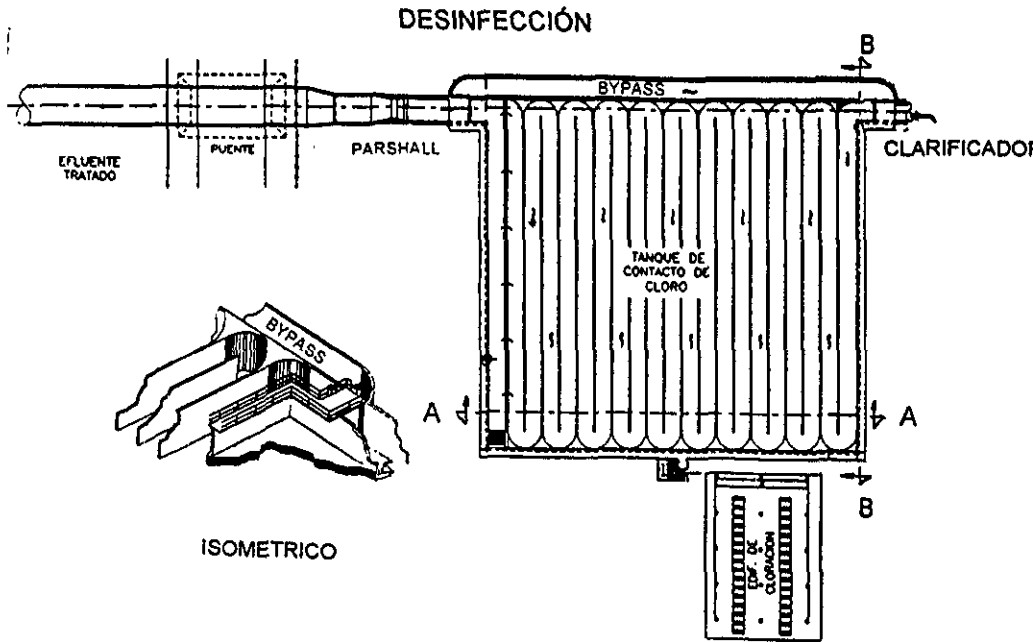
Planta de Desinfección – Parshall – Efluente final
